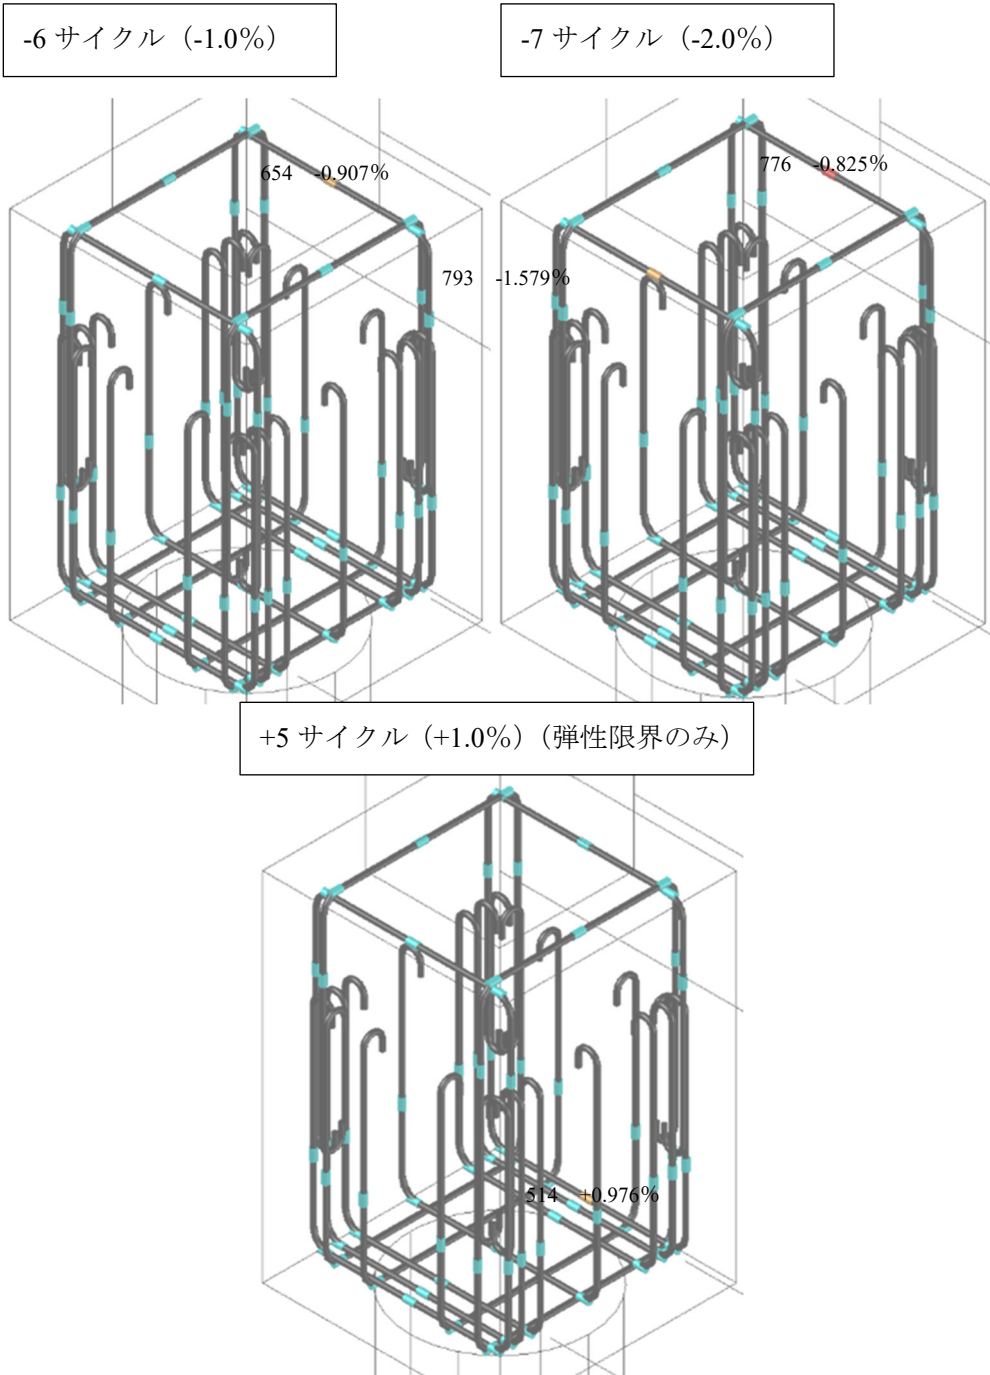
試験体 E-2 パイルキャップ降伏鉄筋
